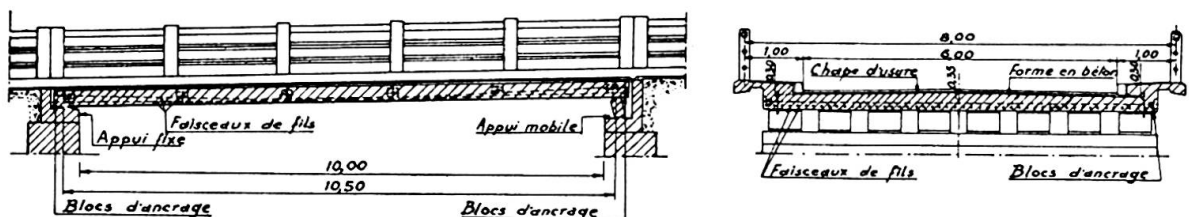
Plan et coupe du pont d'Elbeuf-sur-Andelle.
